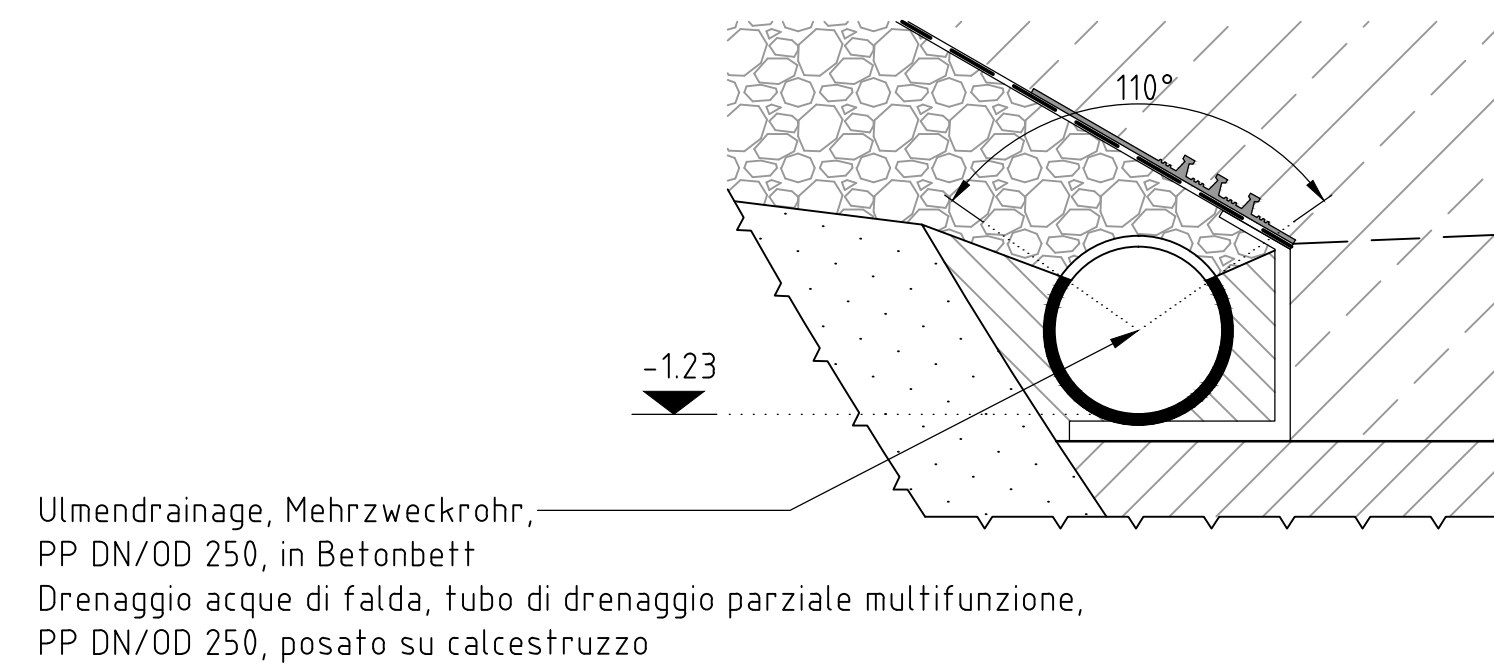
Detail A Anschluss (Noppenbahnstreifen), M 1:10
